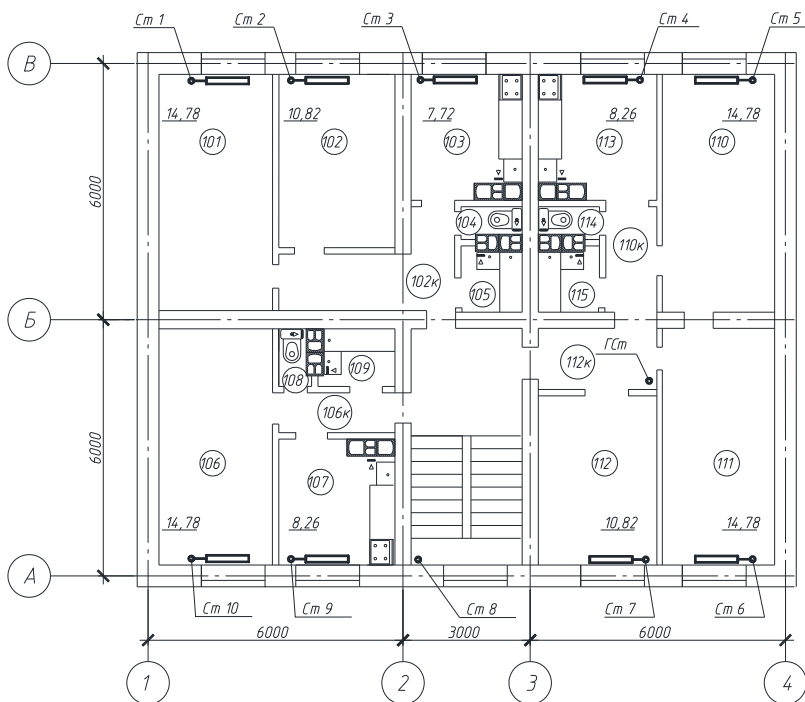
План типового этажа с верхней разводкой трубопроводов и приставными унифицированными вентиляционными блоками
